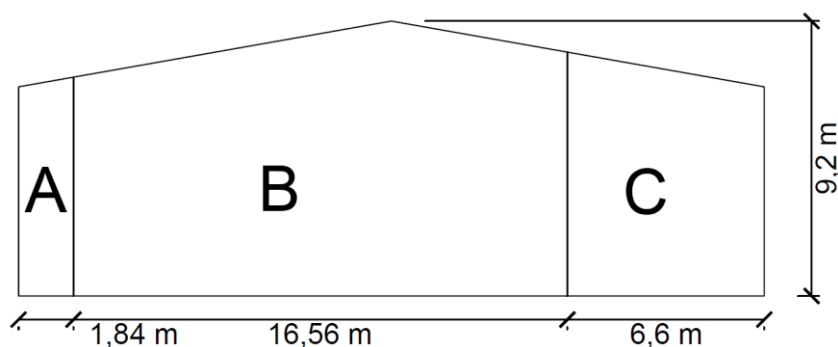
Zonas paralelas al viento cuando actúa por 1 y 3
